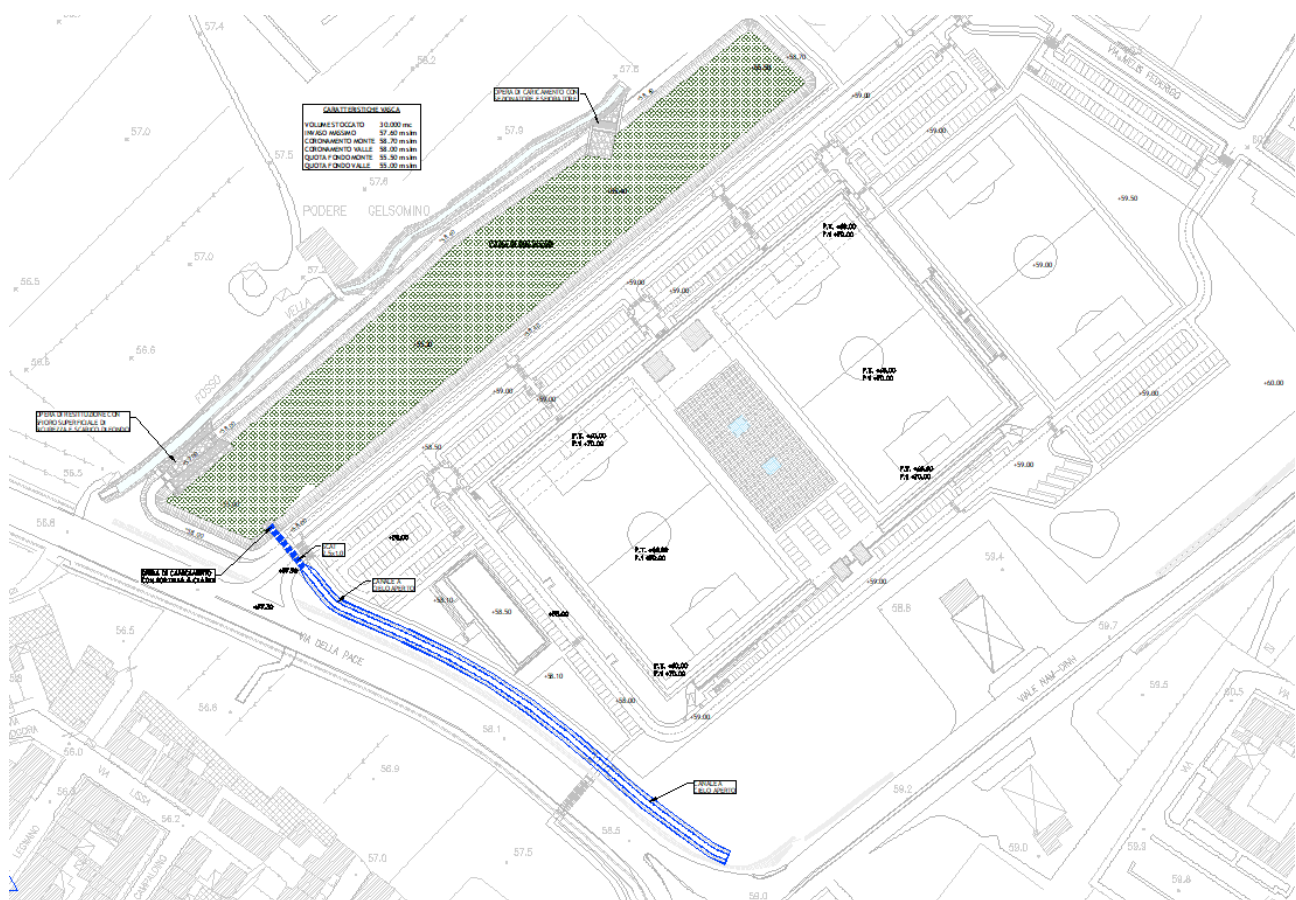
Inquadramento planimetrico delle opere idrauliche nell'area di intervento
